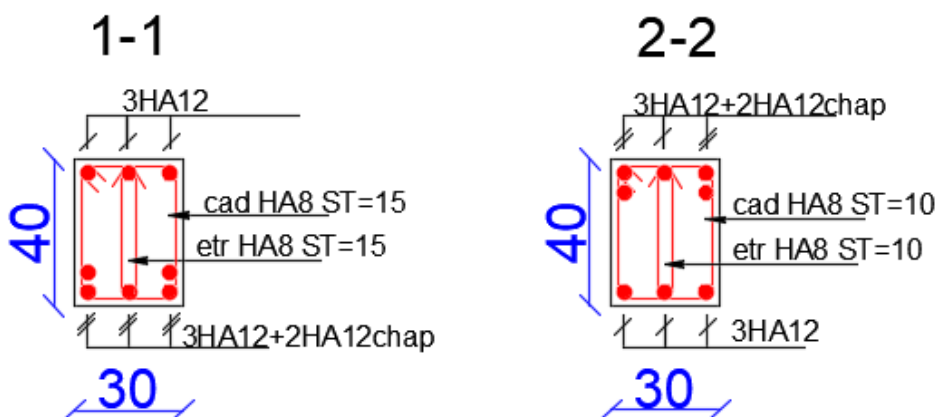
Détails de ferrailage des poutres secondaire.V.2 Etude des poteaux
